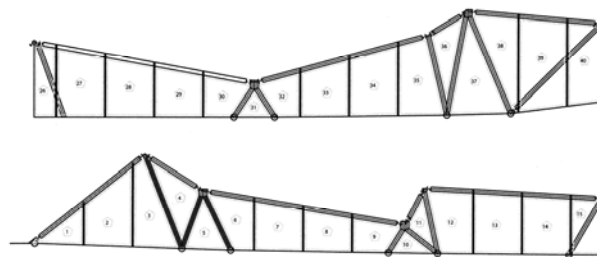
Alçados de estrutura, pavilhão de Zaha Hadid, 2000.
